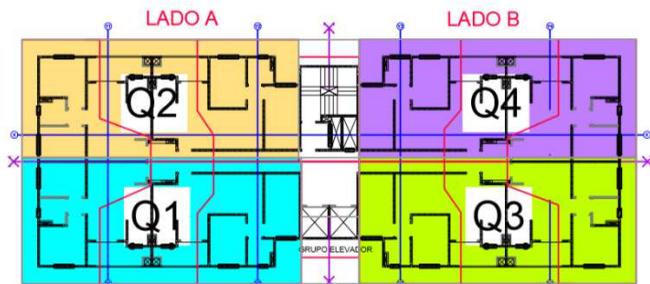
Sequência de execução da alvenaria para o primeiro dia de elevação
